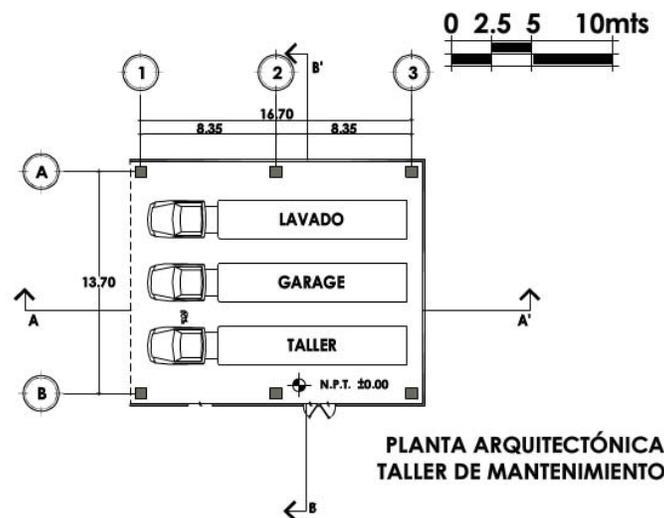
Planta arquitectónica, taller de mantenimiento
